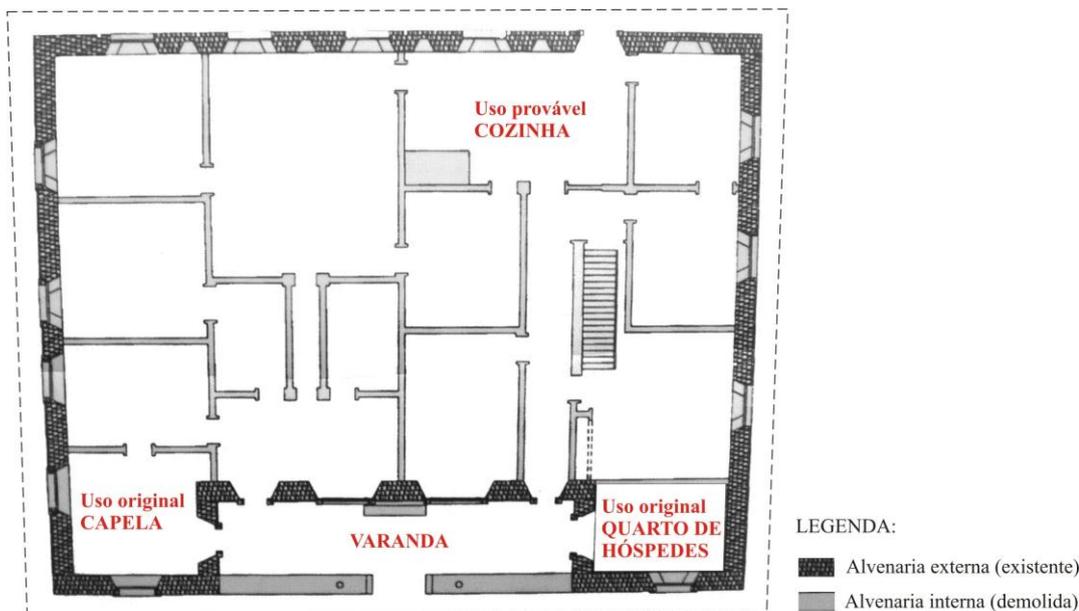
Foto digital da planta da Casa Bandeirista ainda com as paredes internas.
